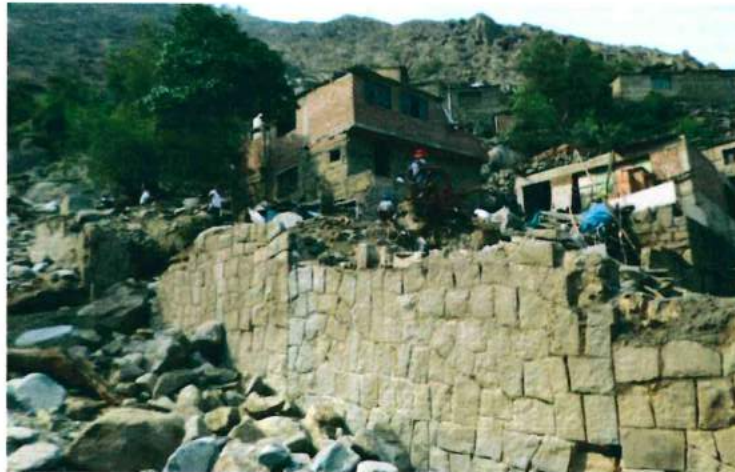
Muro de mampostería de piedra, colapsado por el paso del flujo.
